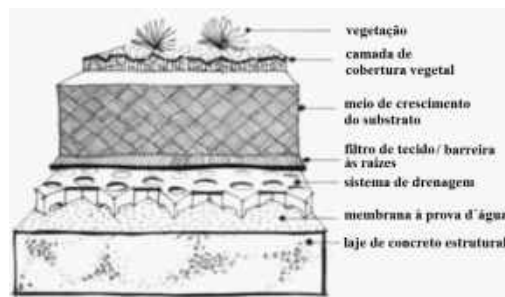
Corte típico de telhado verde. Fonte: *Department of Planning and Local Government (2009)*.
